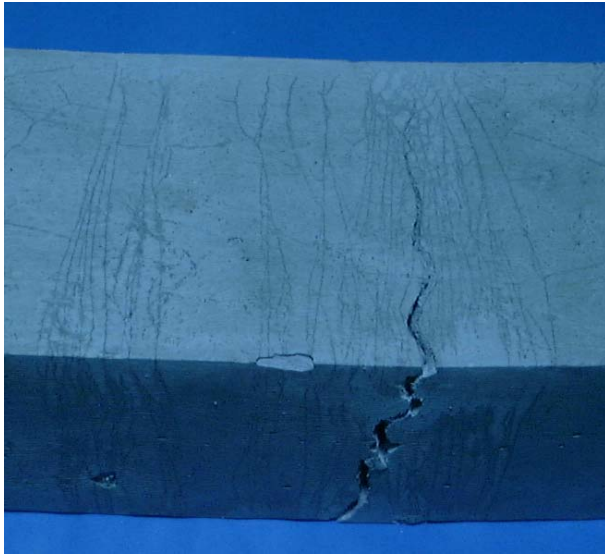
ひび割れ状況：PVA繊維系
